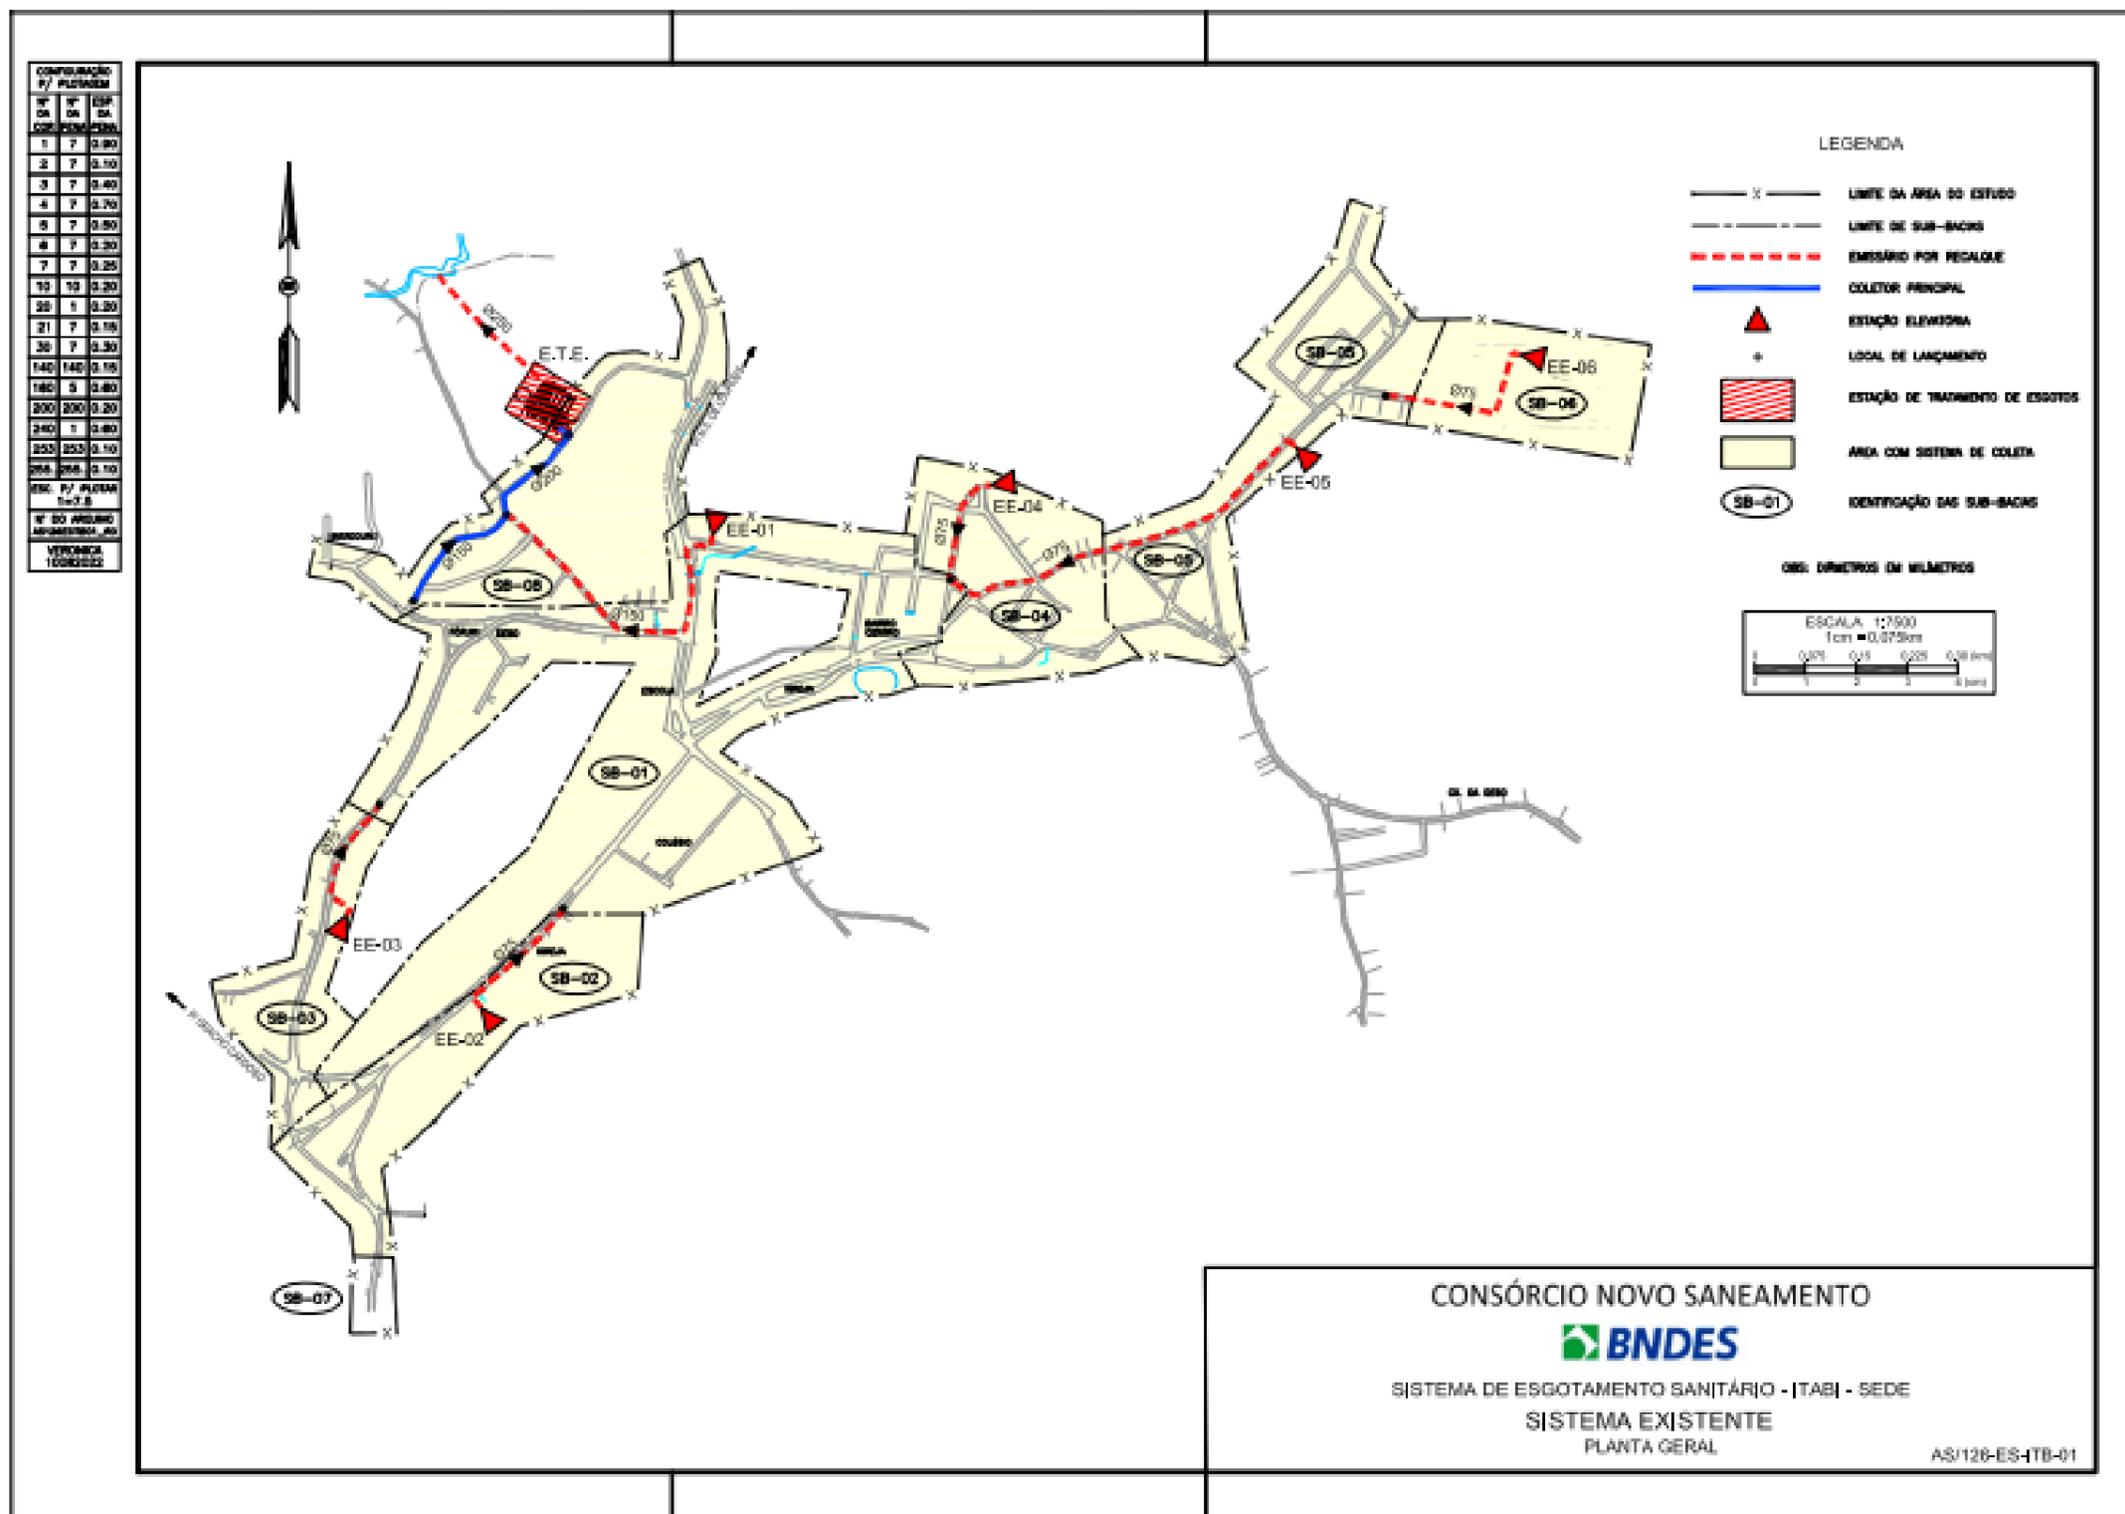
Planta do Sistema de Esgotamento Sanitário – ITABI
